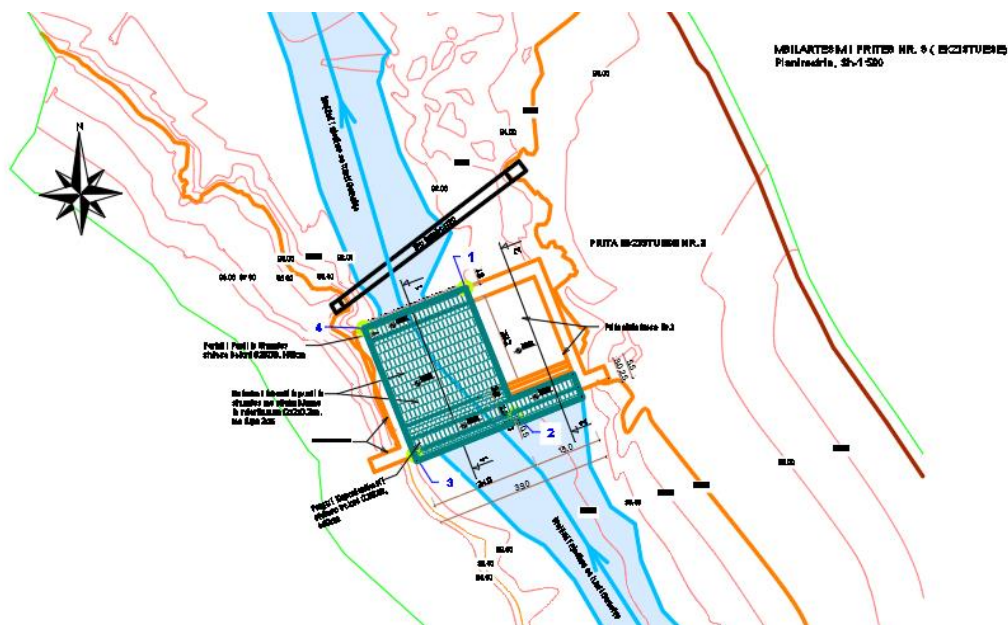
Planimetria e mbilartesimit ne priten ekzistuese Nr.3.
